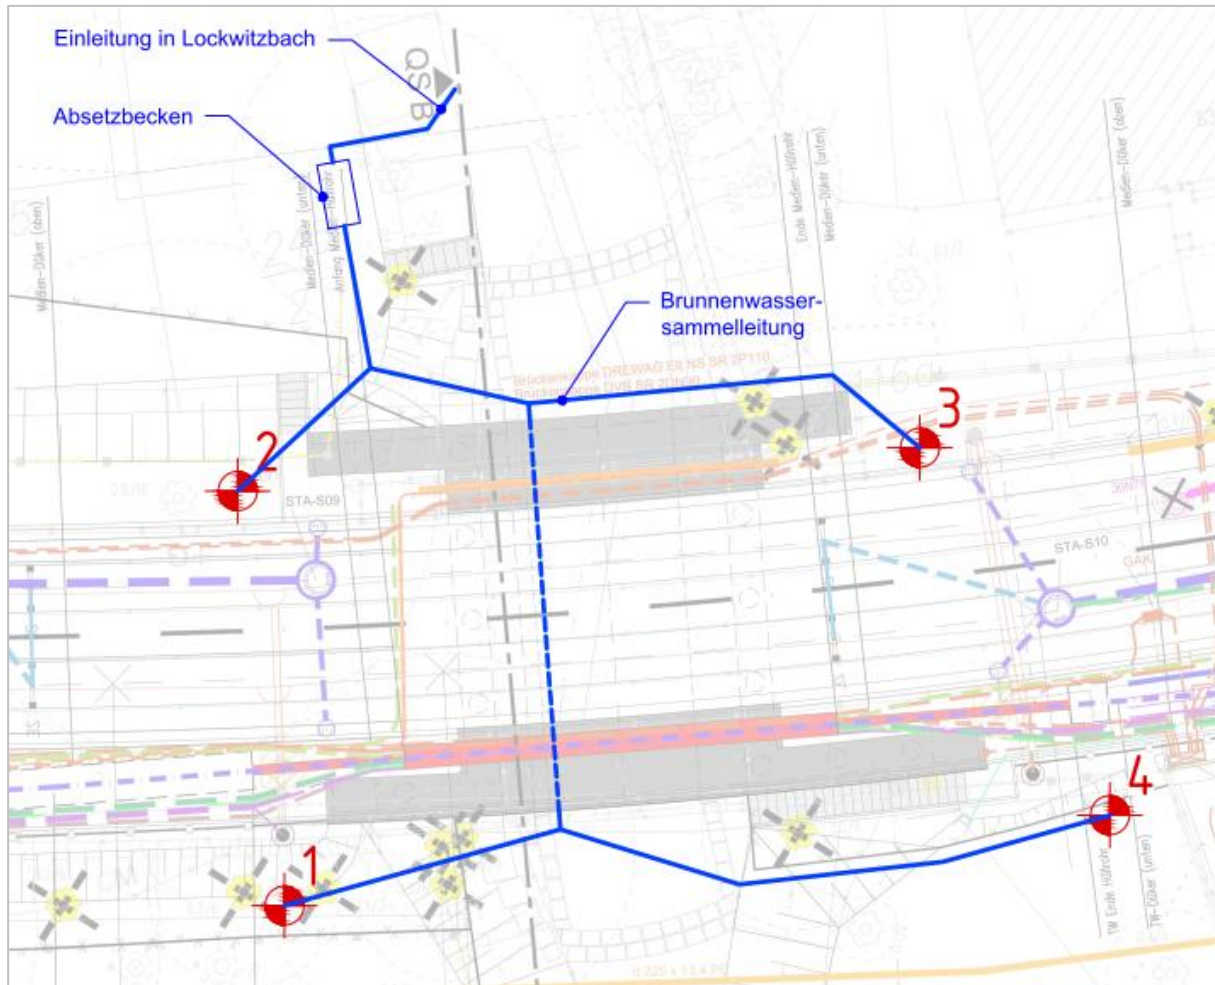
Lageplan - Detail Einleitstelle des während der bztl. Wasserhaltung gehobenen Grundwassers (Auszug aus Anlage 3).
